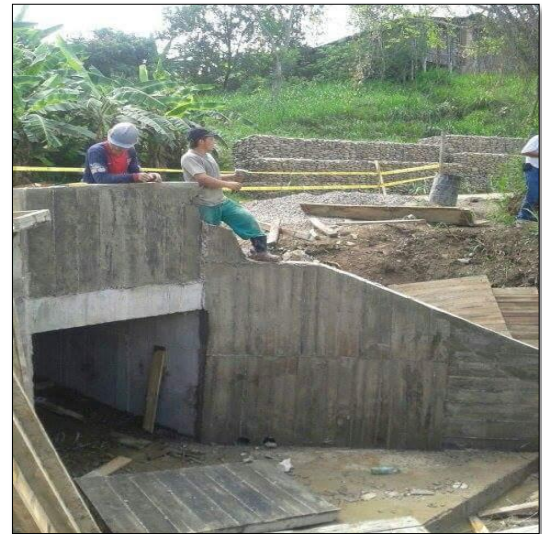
K 25+742 CONSTRUCCION BOX COULVERT
